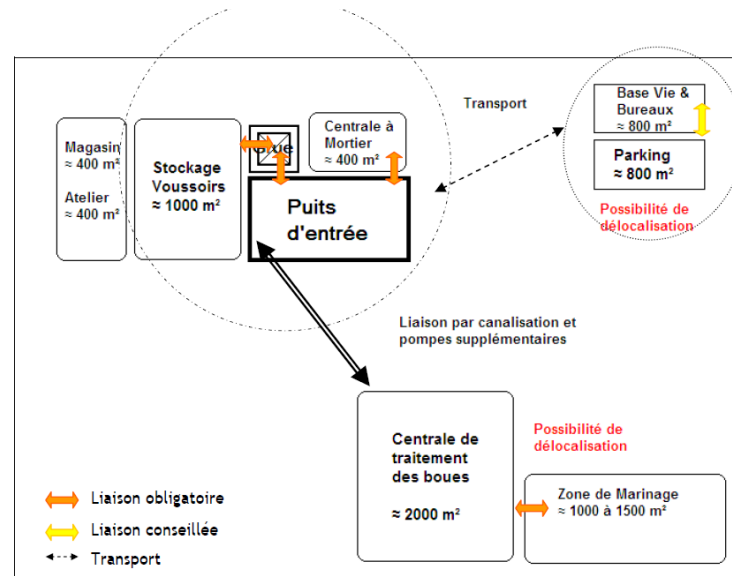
Principe d'aménagement des installations de chantier pour le creusement du tunnel
